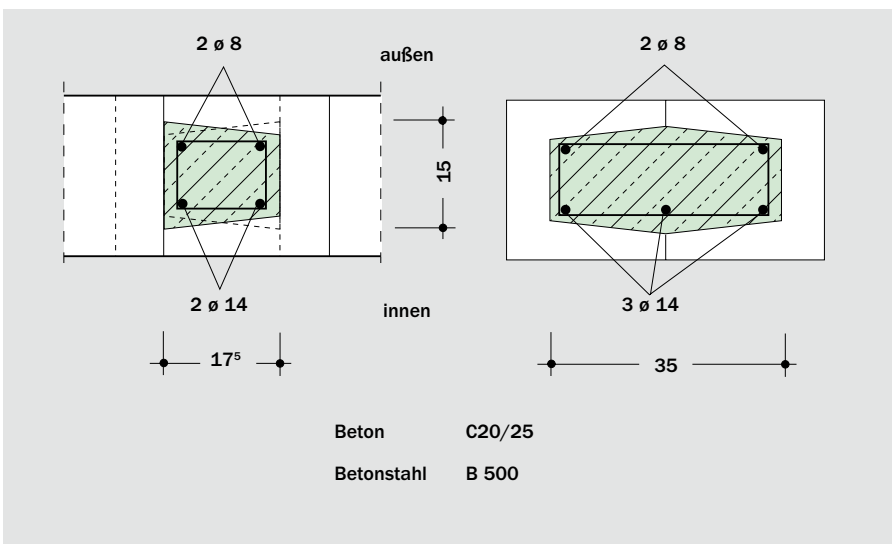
Aussteifende Stahlbetonstützen in 24 cm dicken Kelleraußenwänden unter Verwendung von KS-U-Schalen
